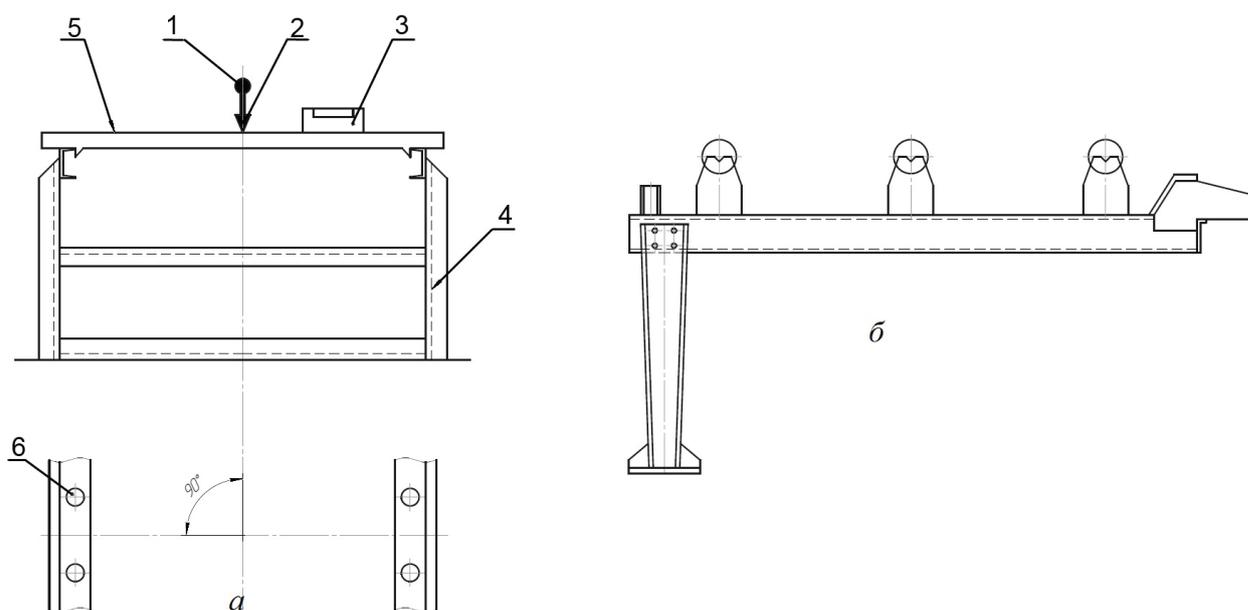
Схема подготовки металлоконструкции к монтажу:
